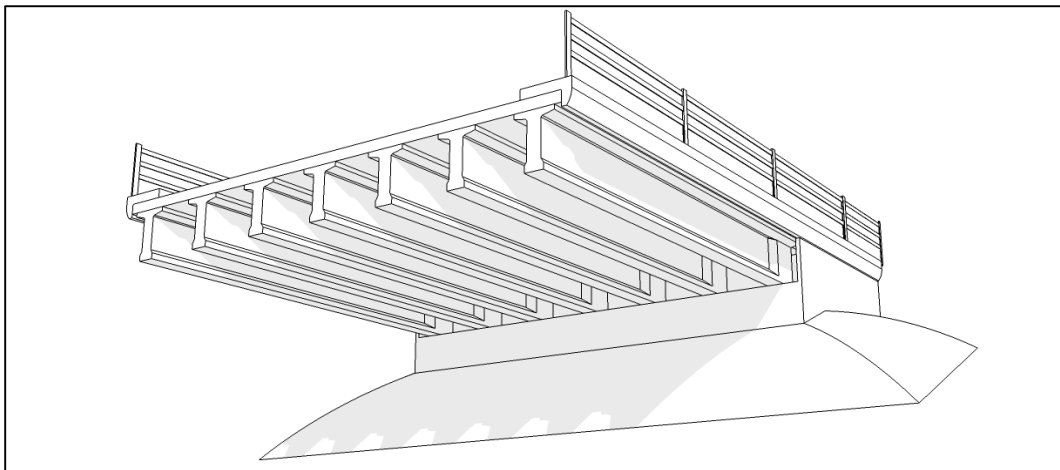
Morphologie générale d'un pont à poutres en béton précontraintes.
